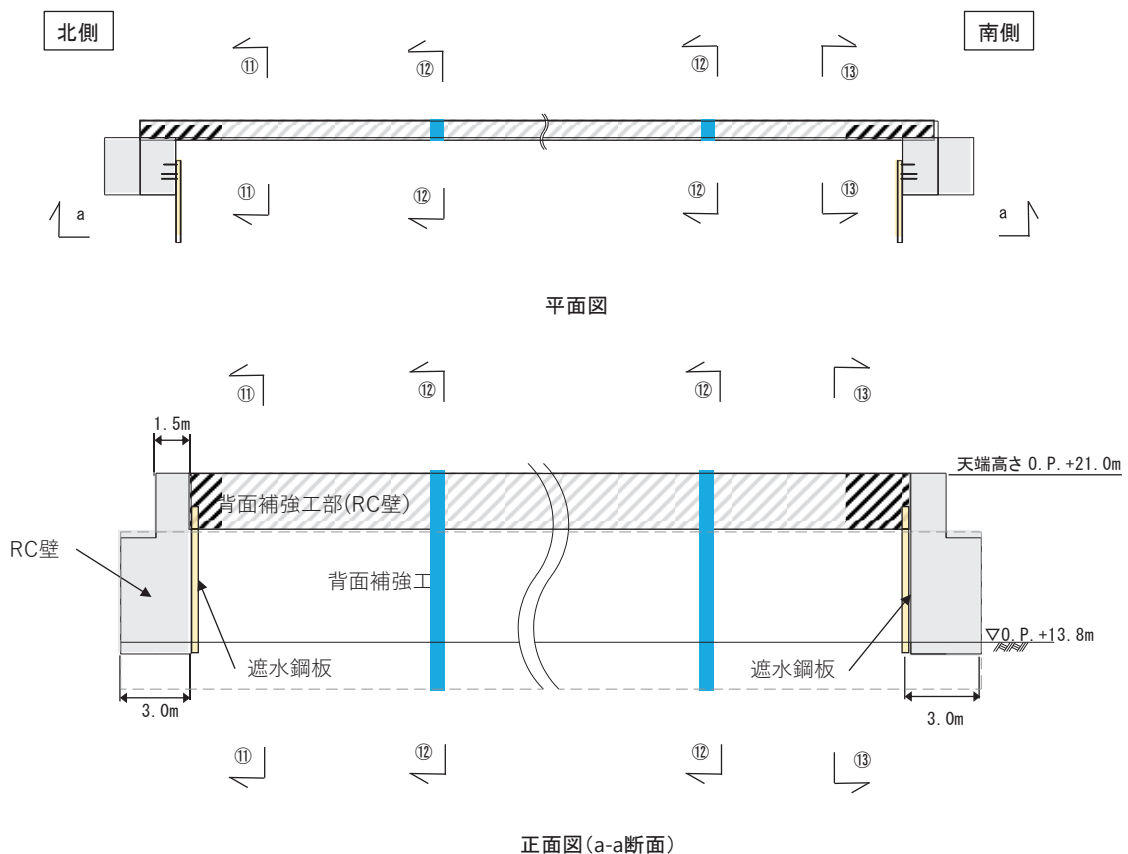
(1) 止水パターン⑪, ⑫, ⑬の構造概要(平面図, 正面図)
